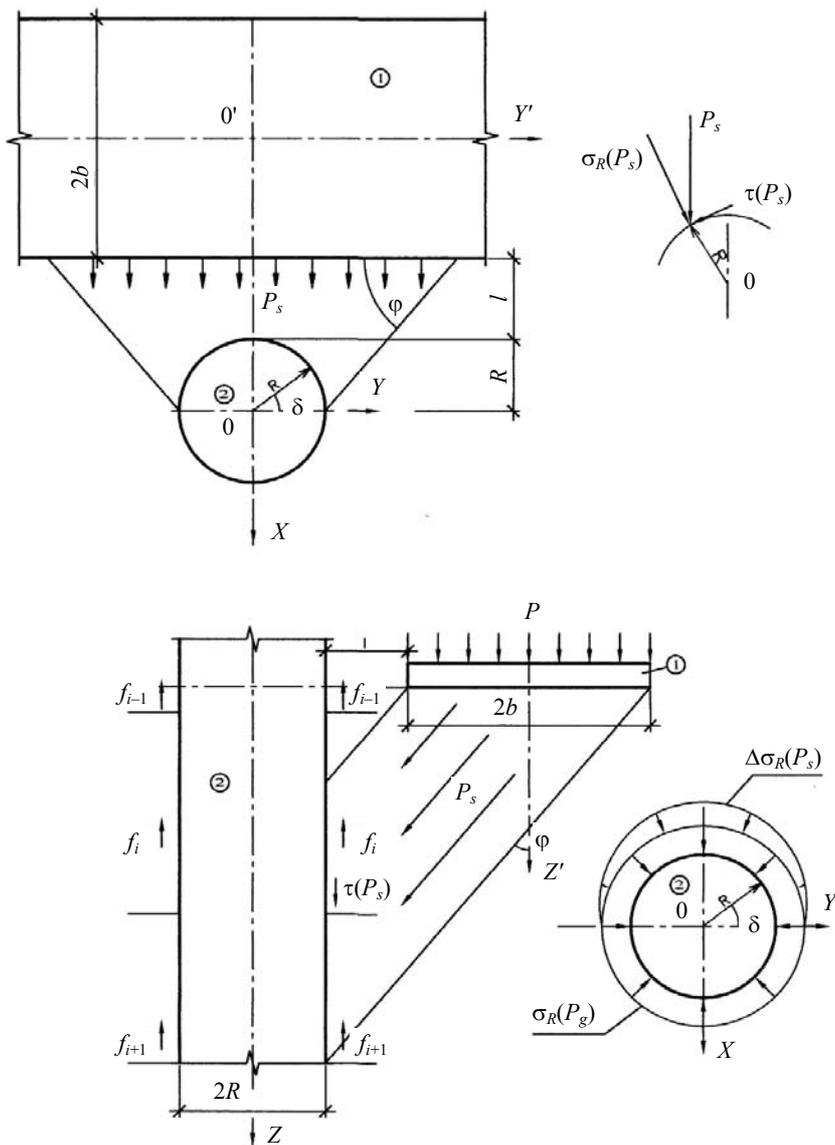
Схема напряжений, действующих от ленточного фундамента (1) на сваю (2)
